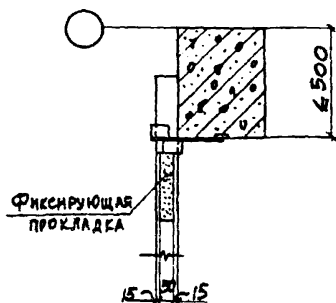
В ПОПЕРЕЧНЫХ ПЕРЕГОРОДКАХ У СРЕДНИХ КОЛОНН ЗДАНИЯ С ВЫСОТОЙ СЕЧЕНИЯ КОЛОННЫ  $\geq 800$
